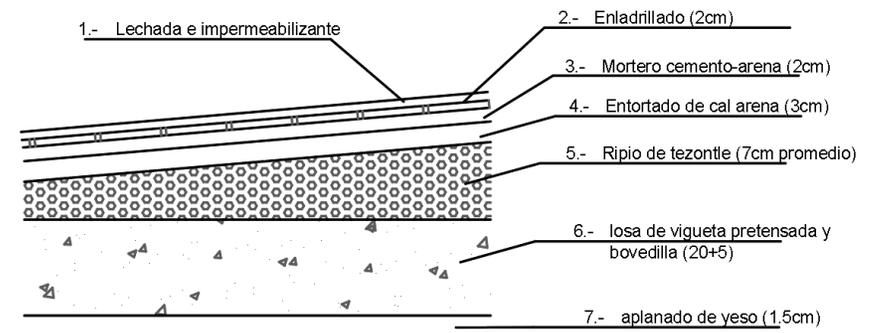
Detalle de cubierta plana a base de vigueta y bovedilla
